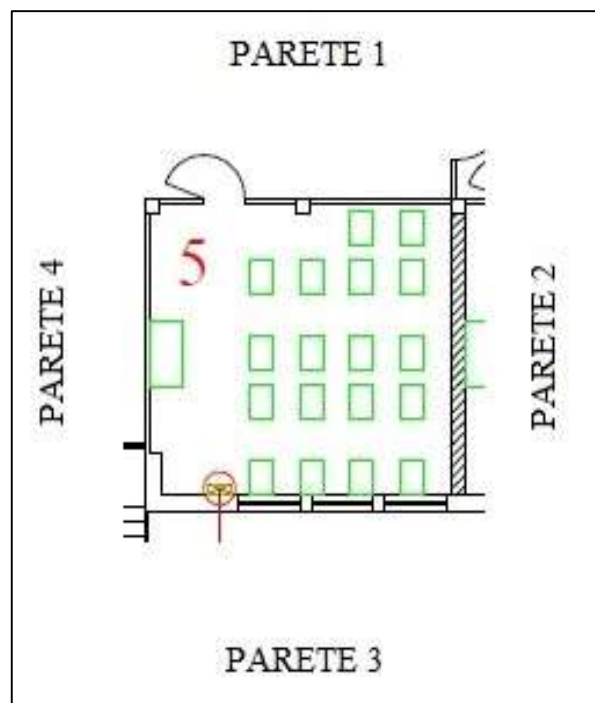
Planimetria dell'Aula 5 (4°B) oggetto di misurazioni
